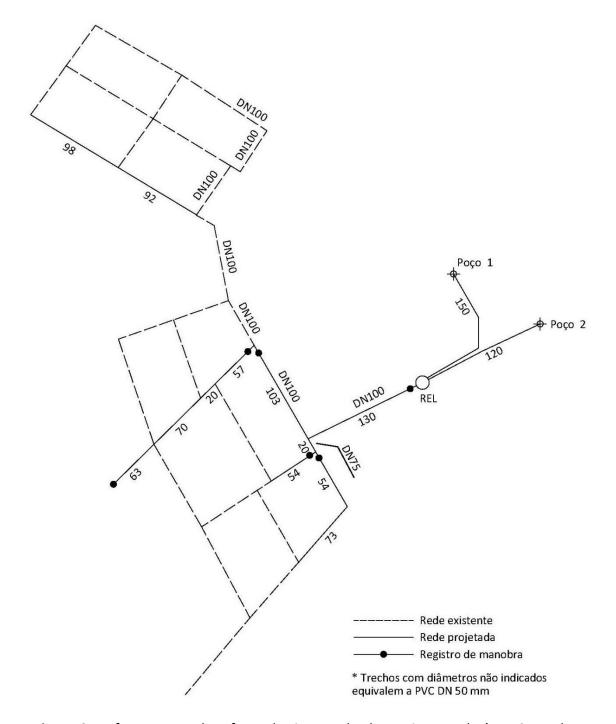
Infraestrutura de reforço do sistema de abastecimento de água Central – Loteamentos São Jorge e São Paulo.
